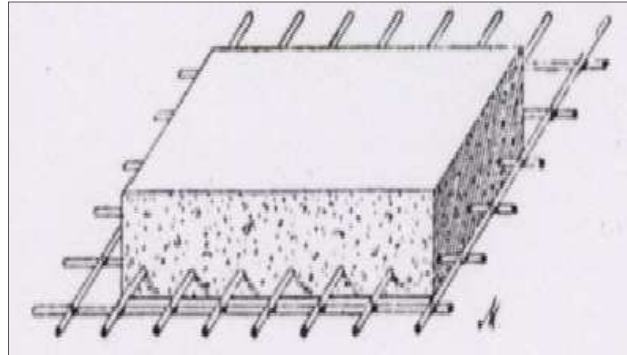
Solaio in cemento armato a soletta piena del tipo Monier
